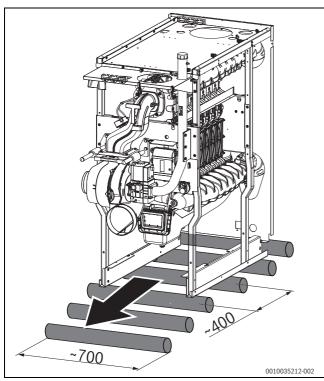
Transport de la chaudière au sol sur rouleaux (dimensions en mm)
